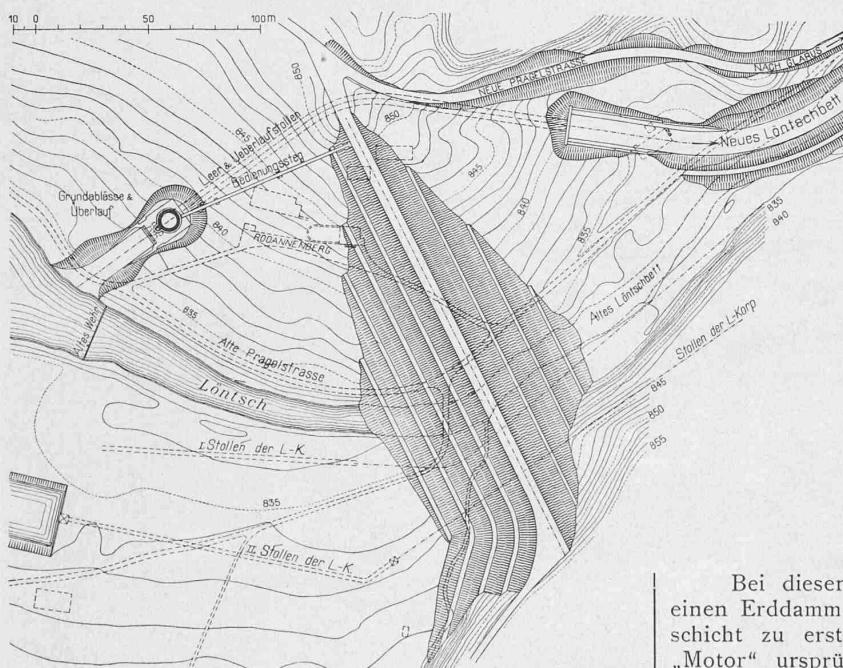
Lageplan des Staudamms mit Grundablass, Leer- und Ueberlaufstollen. — Masstab 1 : 3000.
